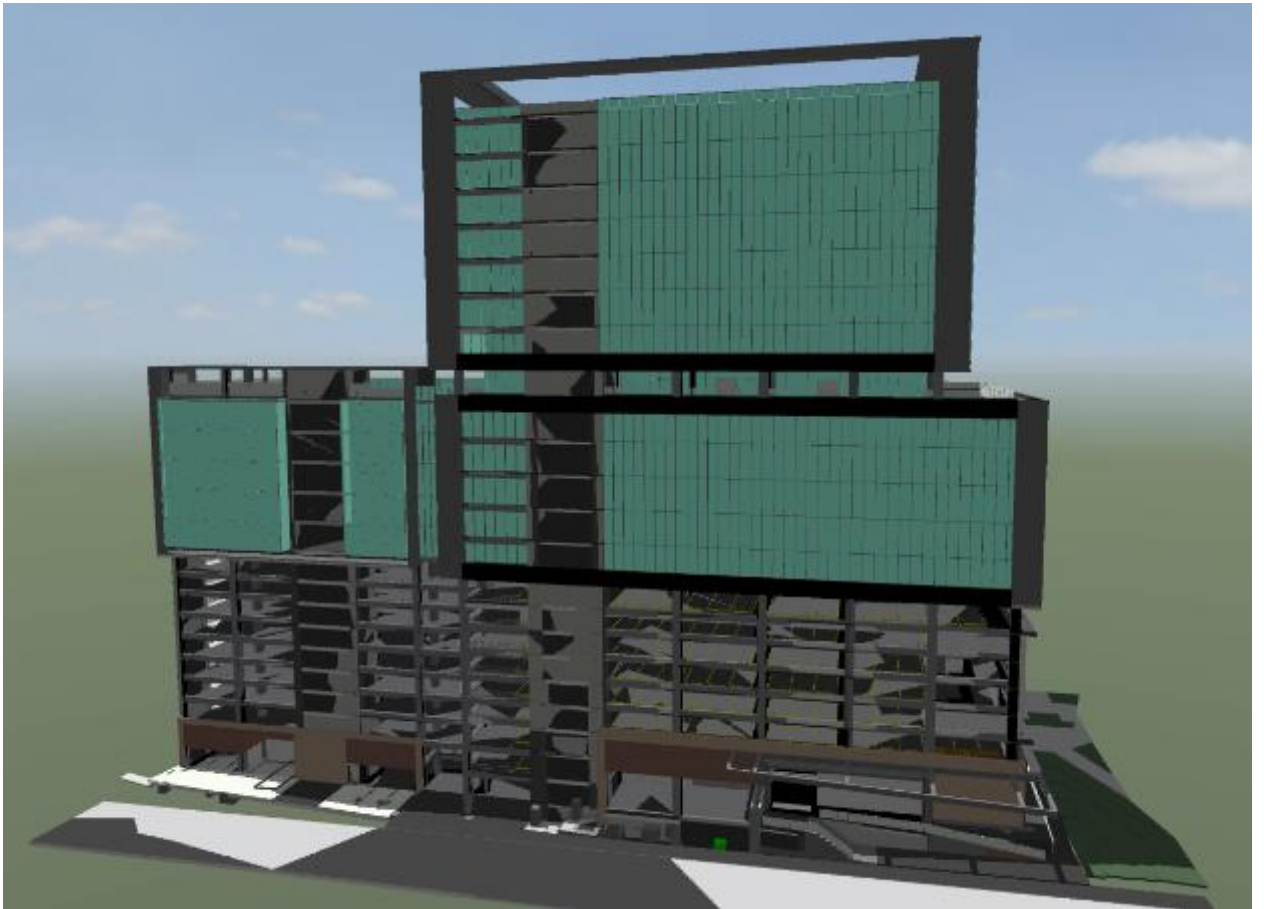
Fachada este. Fuente: Extralum (2019)
